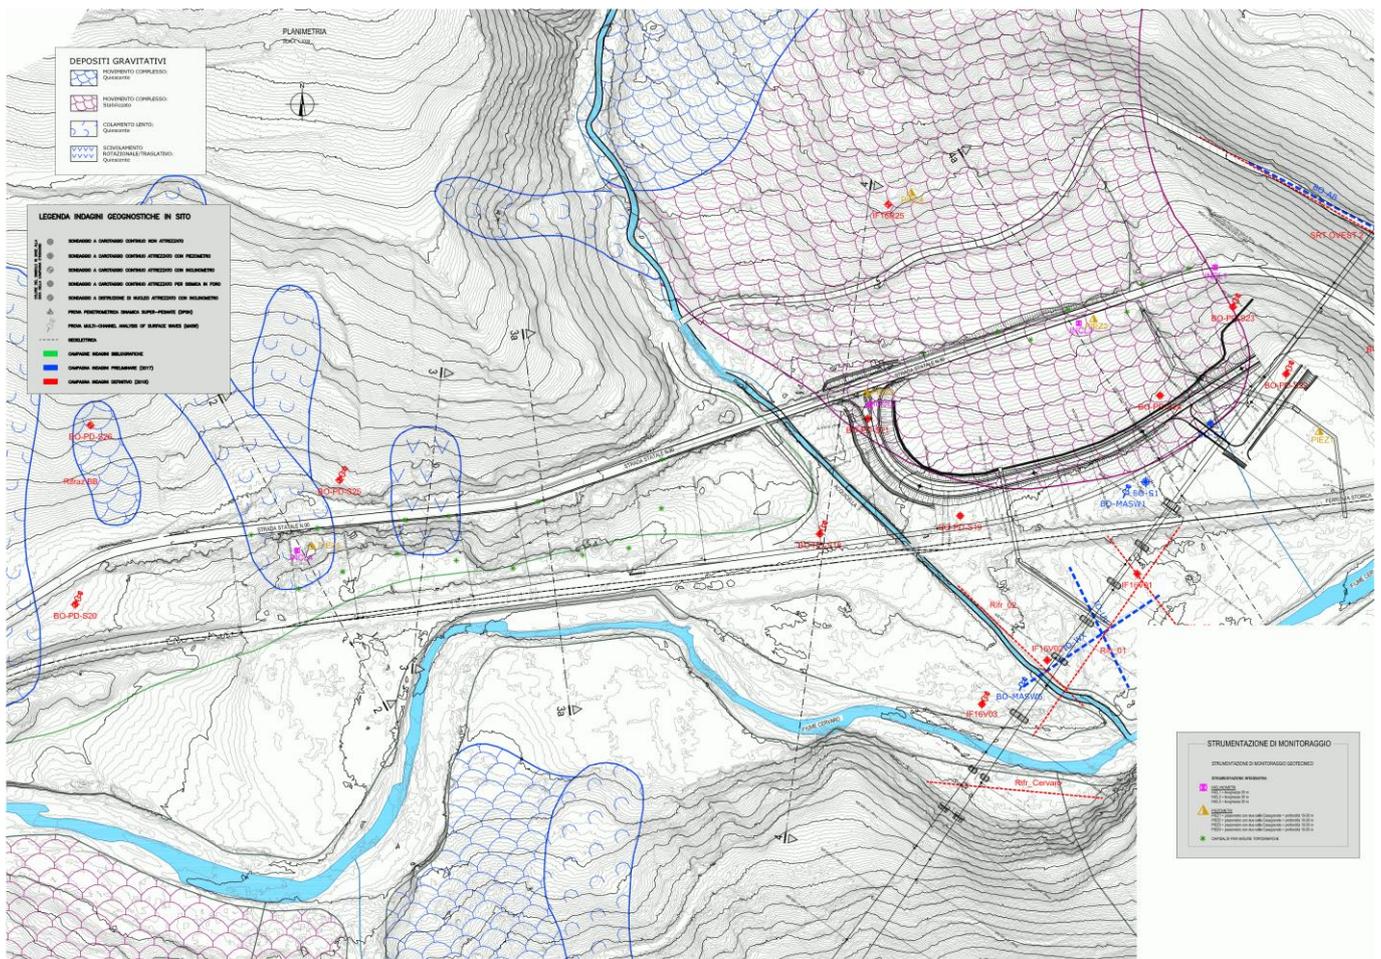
Planimetria generale con ubicata la strumentazione di monitoraggio
